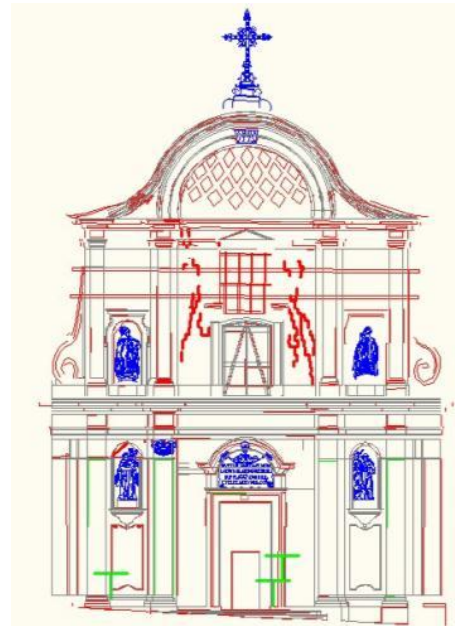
Prospetto, Chiesa Anime Sante, L'Aquila. Set di panorami e restituzione manuale tramite Fotogrammetria Sferica (restituzione di L. Piermattei)
